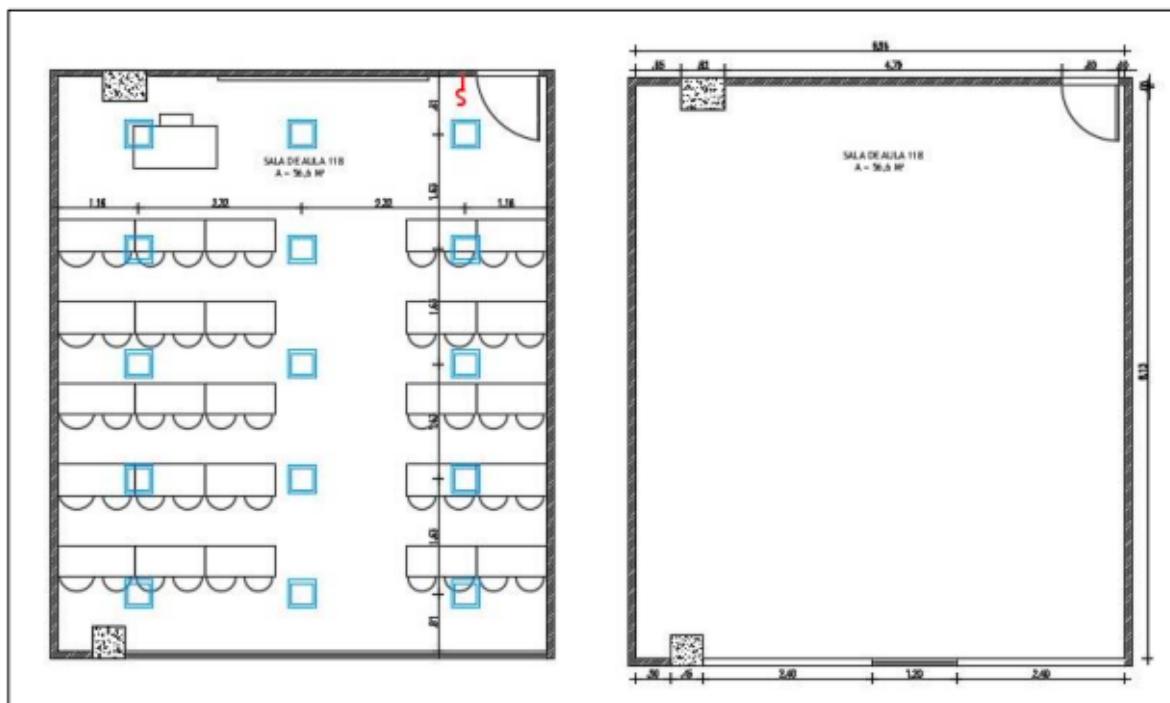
Análise do sistema de iluminação existente. Planta baixa da sala estudada.
